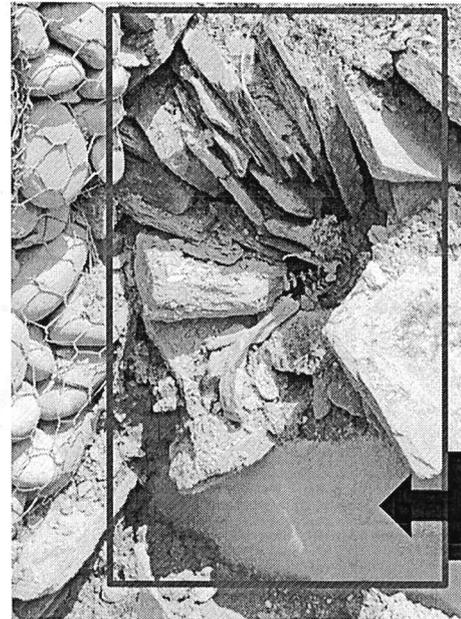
En el muro de concreto armado 1, se verifica que solo existe la presencia de relleno con material suelto y rocas esquistas.
